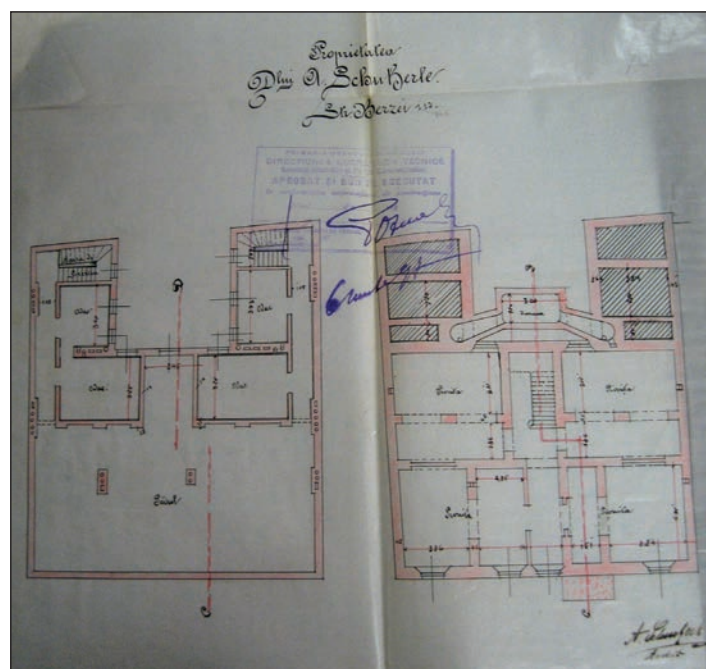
Corpul secundar: plan pod și plan subsol – în anul 1897
